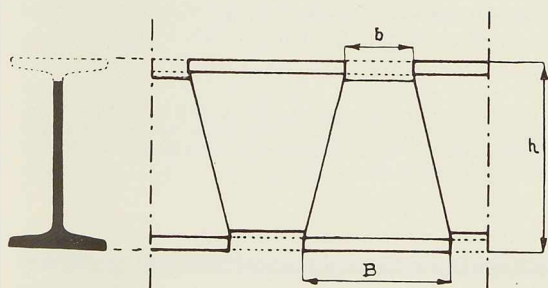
Poutrelle I découpée pour assemblages. (B et h sont fonction du nombre de rivets ou boulons nécessaires à l'assemblage ; b est égal à la largeur d'aile de la poutrelle.)
